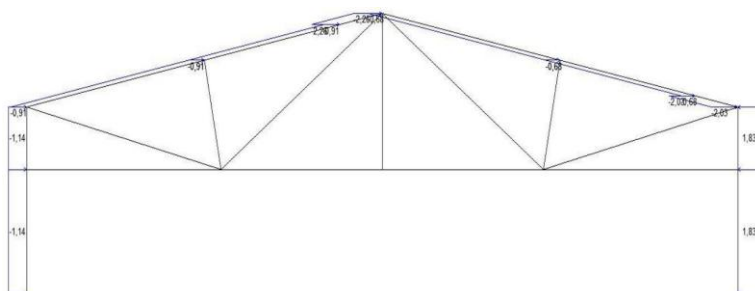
Вітрове навантаження на ферму та колону, варіант 1
